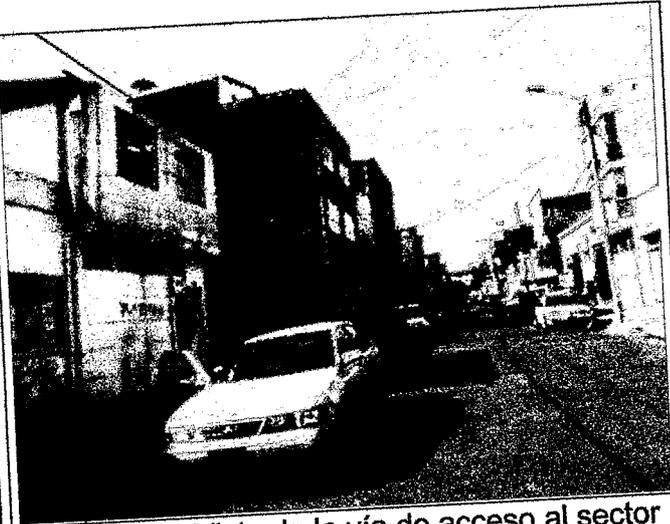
Vista de la vía de acceso al sector en sentido Norte – Sur, Cra. 53
